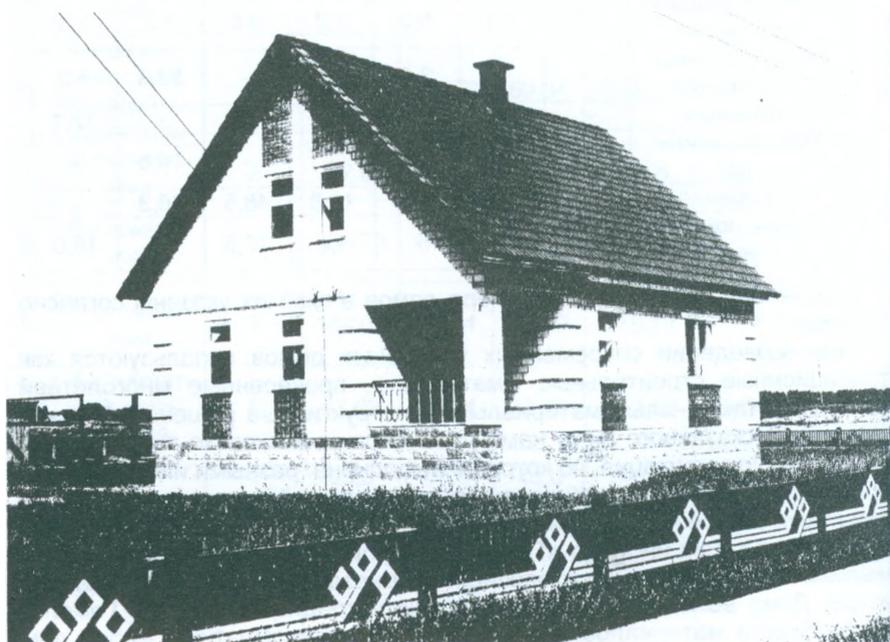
Трехкомнатный жилой дом с летней мансардой в населенном пункте Вышедки Городокского района
